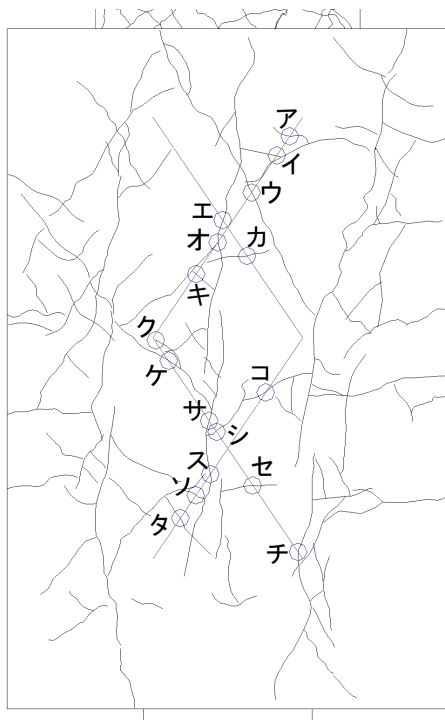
パイルキャップひび割れ幅測定位置 (試験体 A-1 負荷荷)
